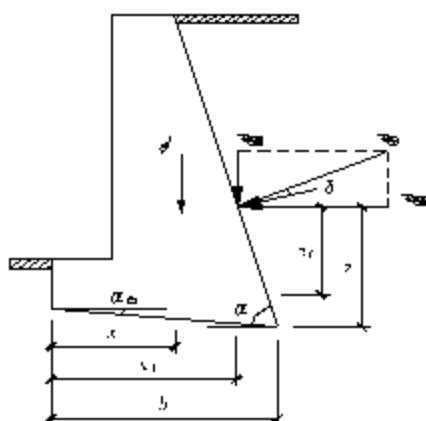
挡土墙抗倾覆稳定性验算示意图
